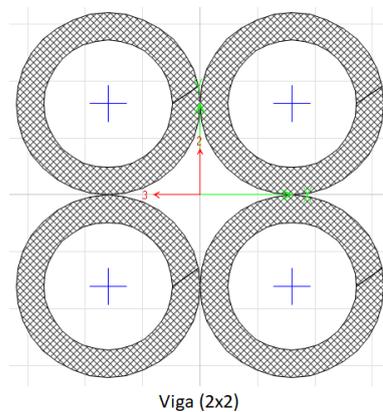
Sección transversal de vigas longitudinales. Fuente: Propia
